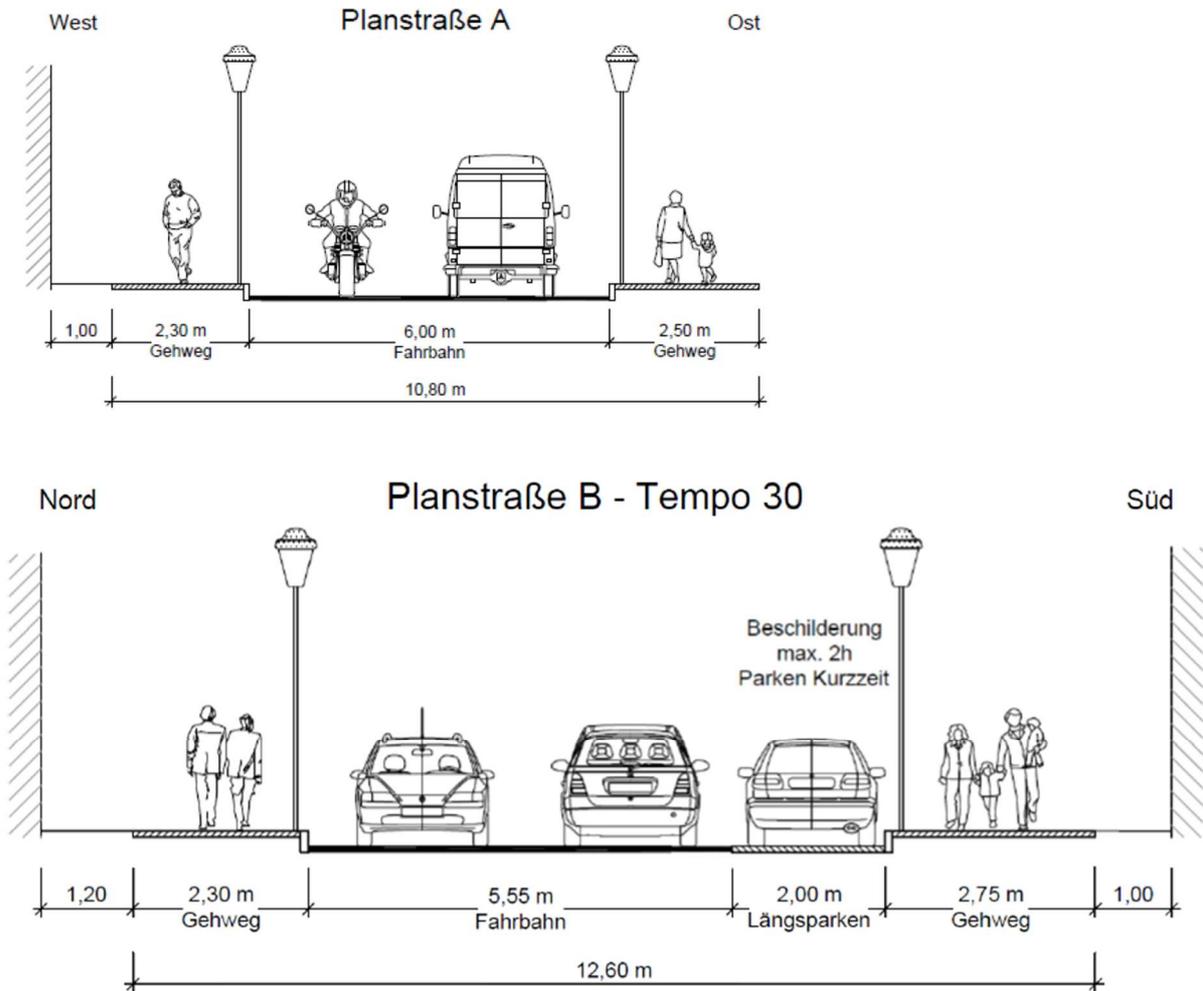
Regelquerschnitte Planstraße A und B gem. Begründung zum B-Plan 122 (2. Entwurf)
